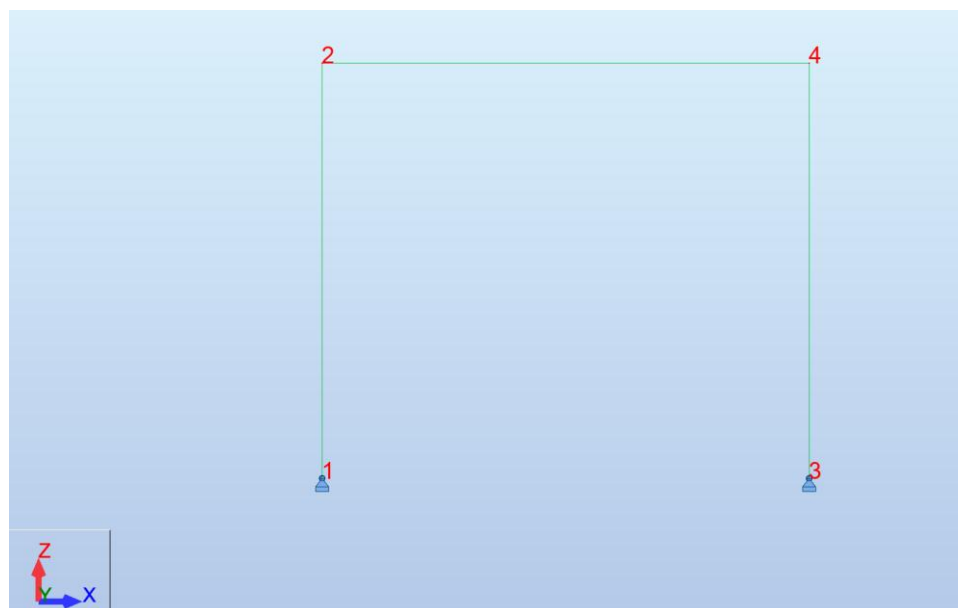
Portique de contreventement en façade – Portique en bas de pente
